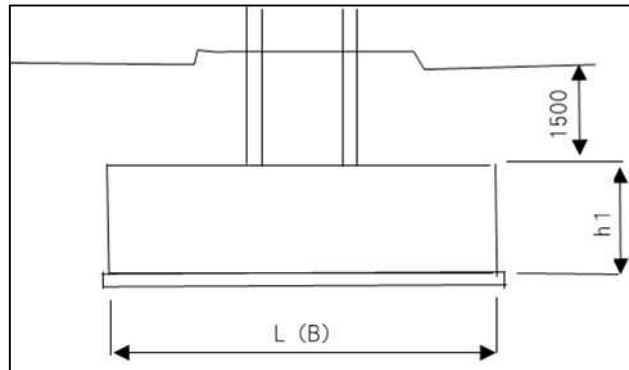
フーチング形状の基本 (要領図-3.76)
